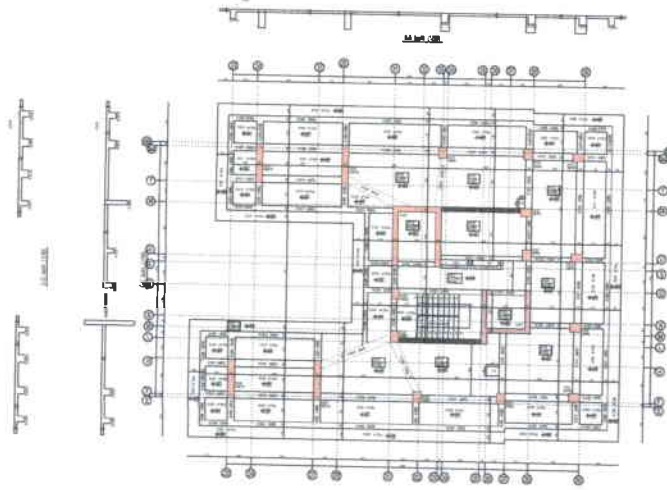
B Blok 2.Bodrum Kat Kalıp Planı
